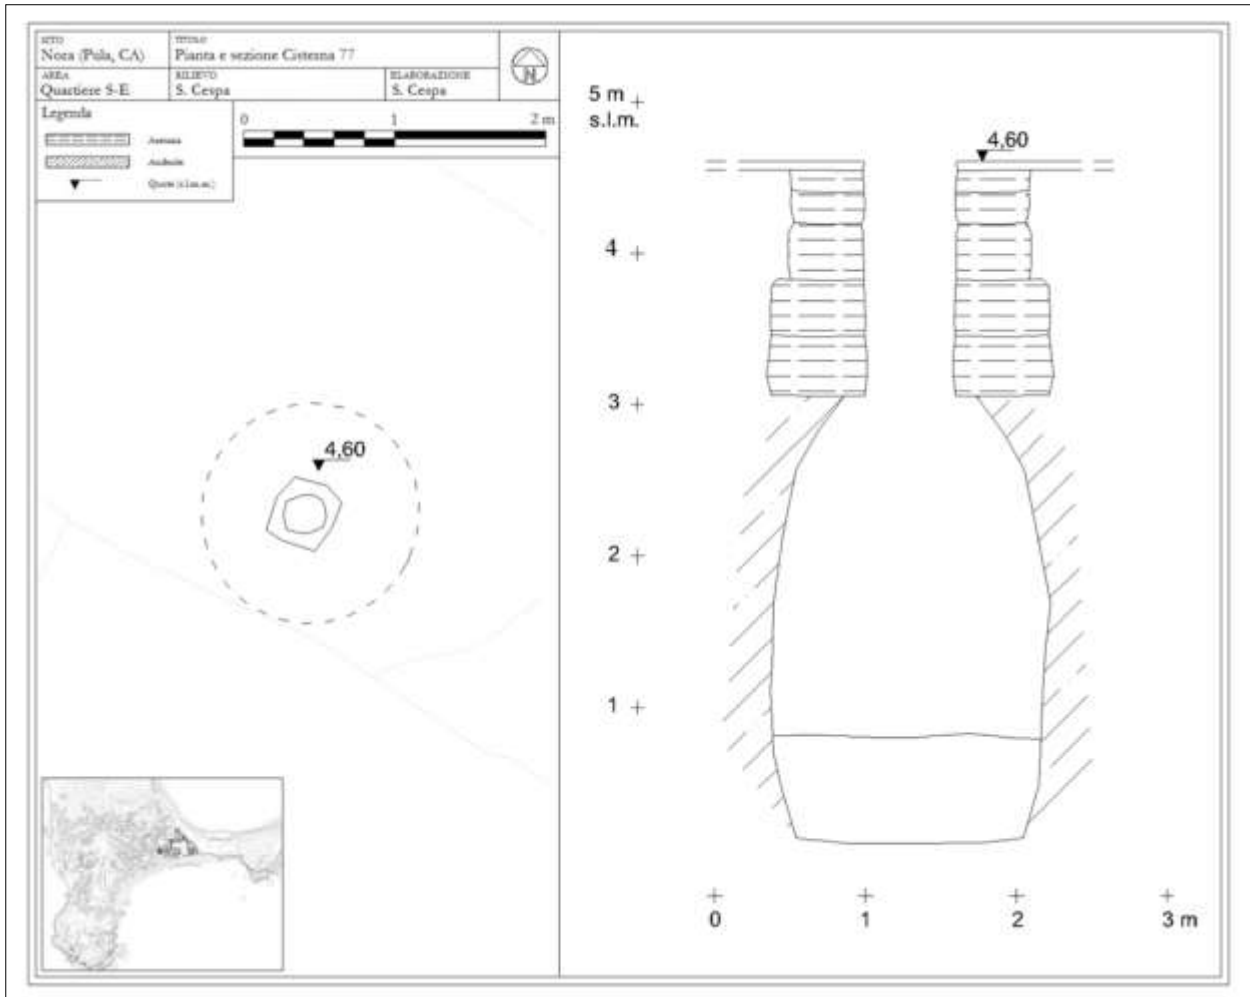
Pianta e sezione della cisterna 77 (elaborazione dell'autore).
